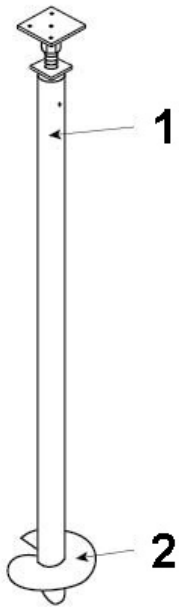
Pieux Vissés Vistech / Postech Screw Piles
